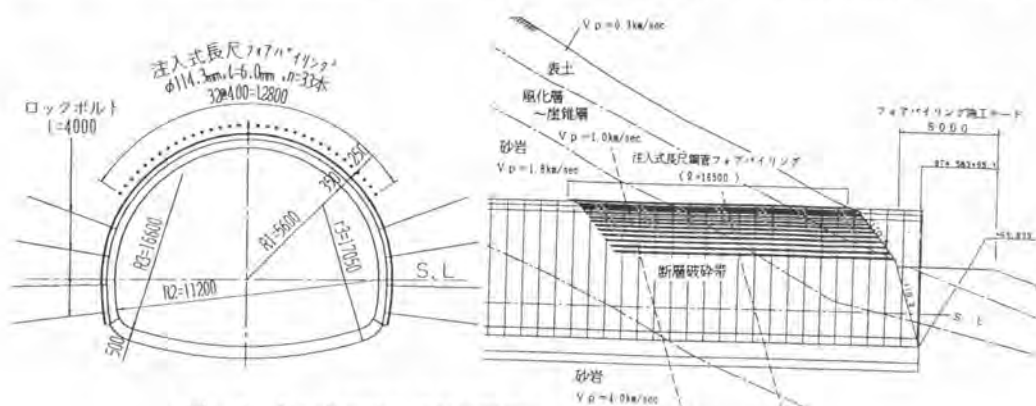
坑口部の注入式長尺鋼管フォアパイリング施工断面図
